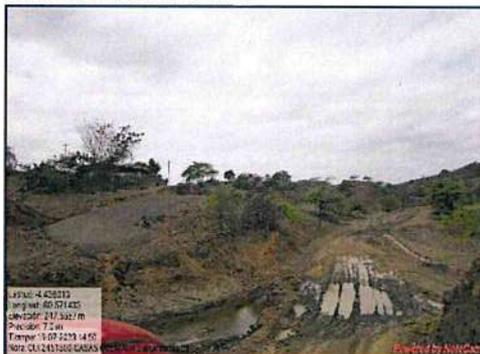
Aprox. Progresiva 13+873 se encuentra alcantarilla N°19, realizando trabajos vaciado de concreto en muros y aleros.
